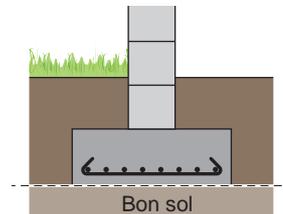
Fondations superficielles reposant sur le bon sol
